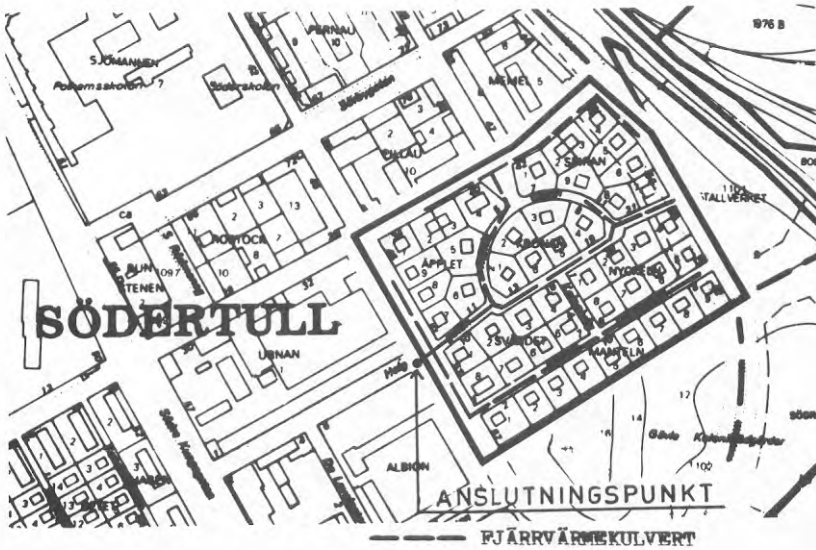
PLANERAT KULVERTNÄT VID FJÄRRVÄRME
